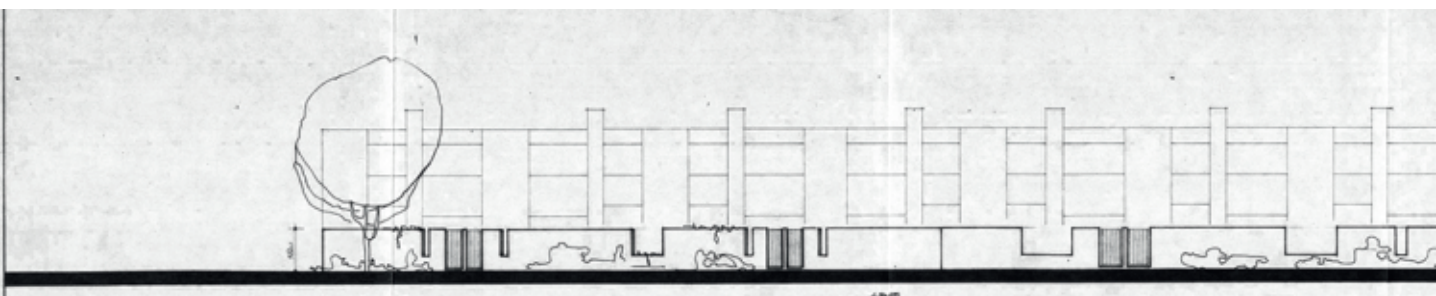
Situatietekening voor aanzicht tuinmuren, 1974
